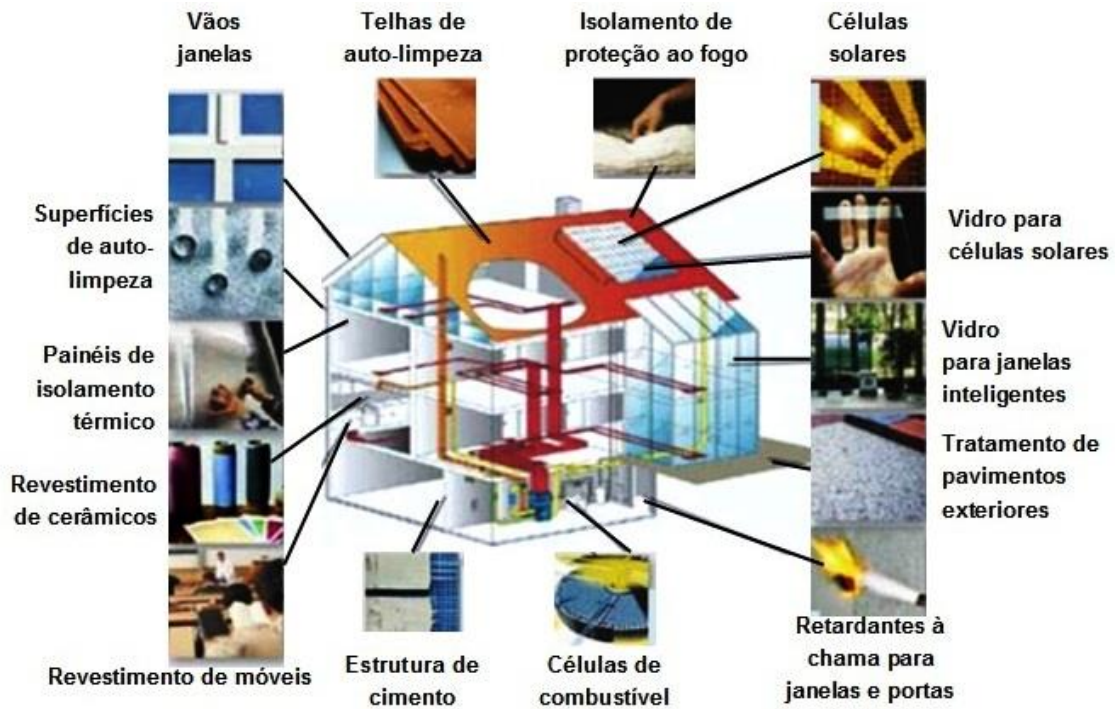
Aplicações de nanomateriais na Construção [adaptado de NANO@CONSTRUÇÃO, 2011]
